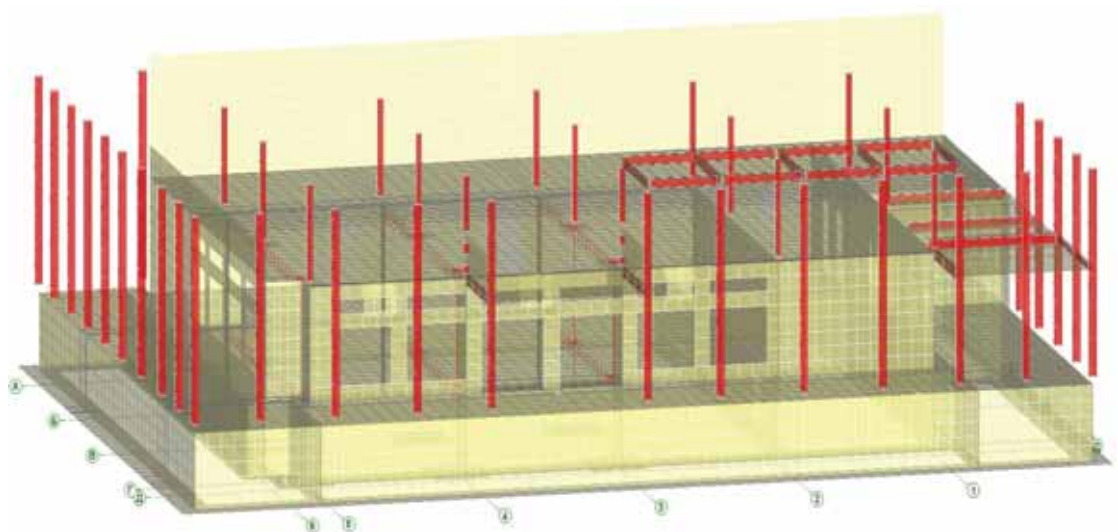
Расчетная схема МКЭ здания в момент 4-го цикла нивелирования
